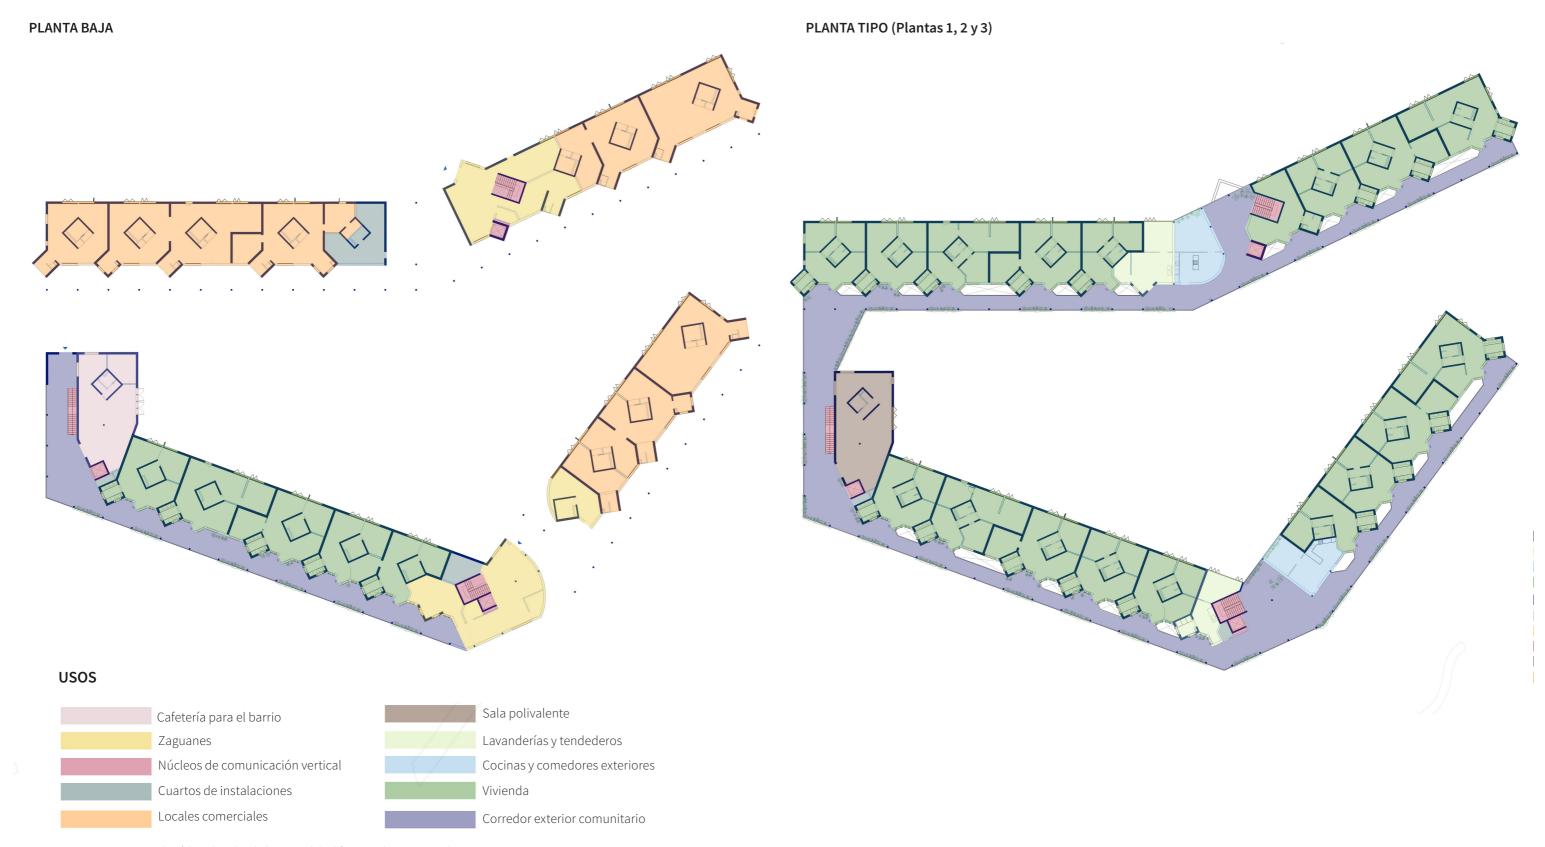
Esquema de código de color de los usos del edificio en Planta Baja y Plantas 1, 2 y 3
